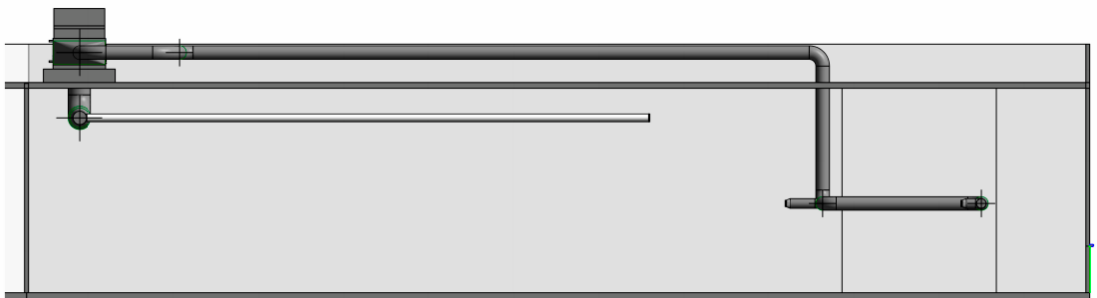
Corte Transversal das condutas de insuflação e extração.
